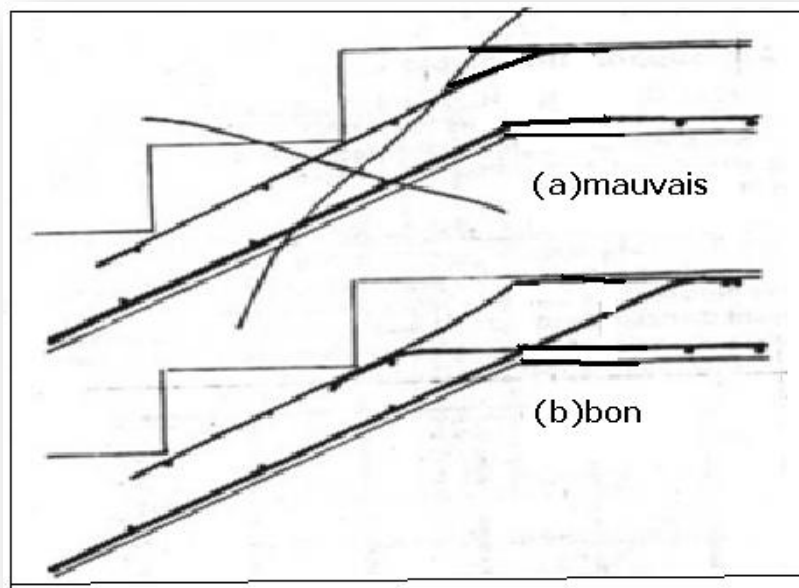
ferrailage d'un raccordement de paillasse d'escalier et de palier.
